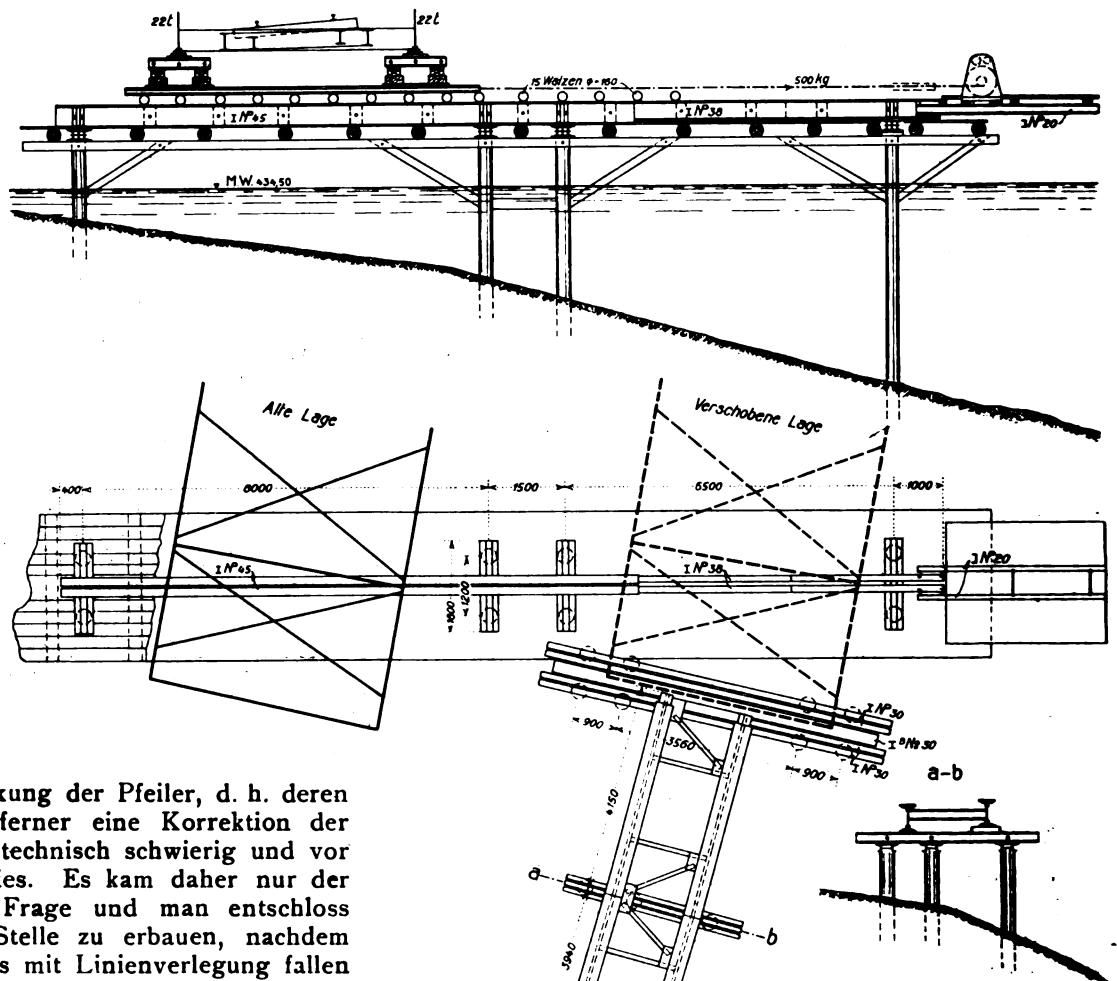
Verschubbahn bei Widerlager I mit Rollenbahn (R in Abb. 1); im Grundriss Anschluss-Balkenträger für das provisor. Geleise.
